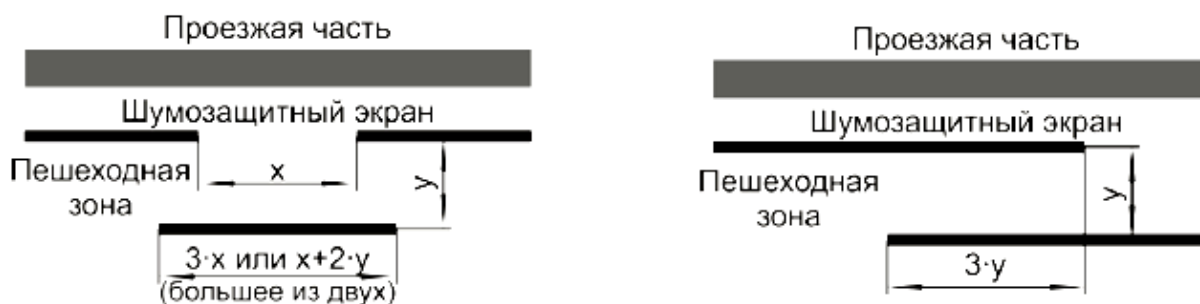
Схема устройства экранов на участках разрыва и перекрытия
